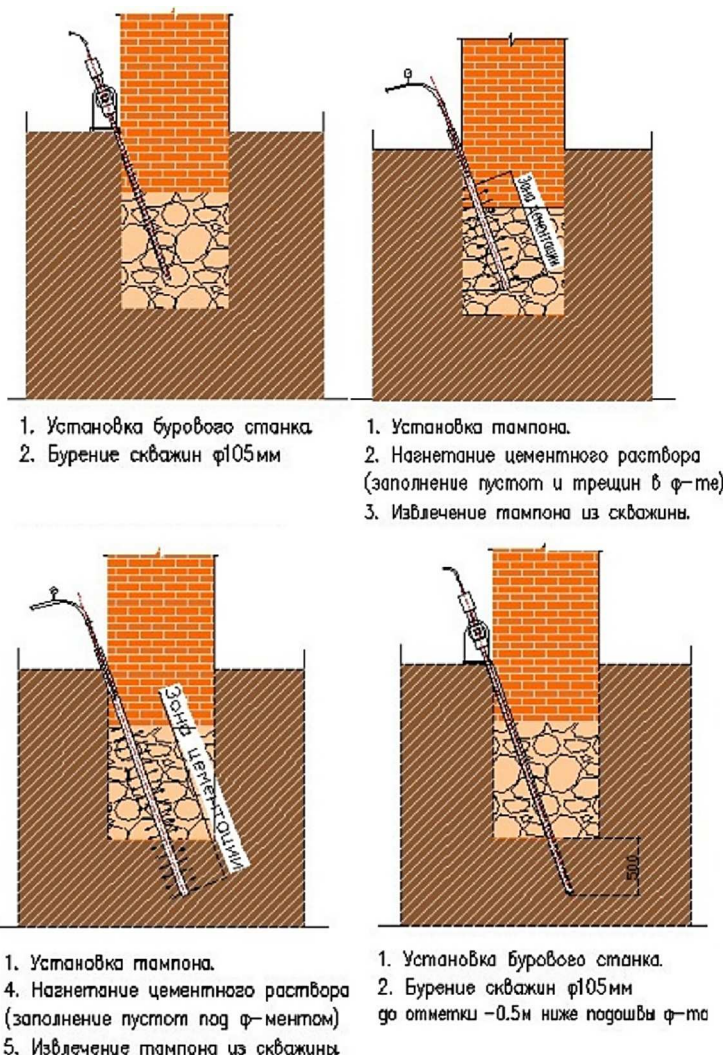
Усиление фундаментов методом цементации пустот в кладке
